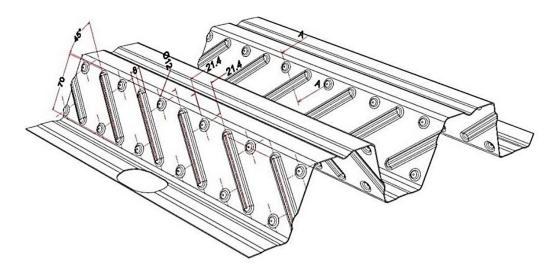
Les dimensions du bac d'acier cofraplus55
